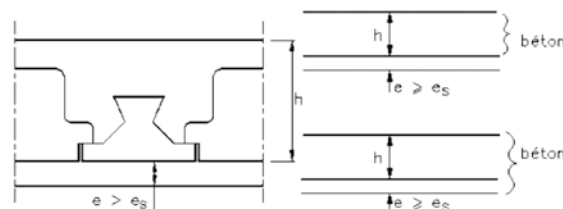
Cas d'un plancher avec enduit protecteur d'épaisseur suffisante e_s
